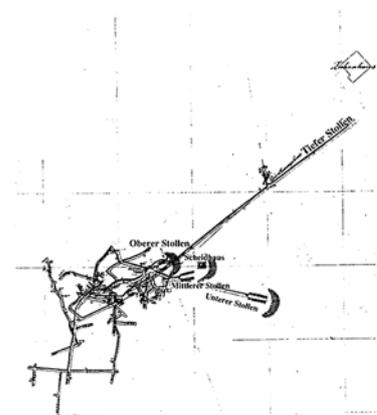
Grundriss Theresia – Quelle: Ehem. Preuß. Bergamt
